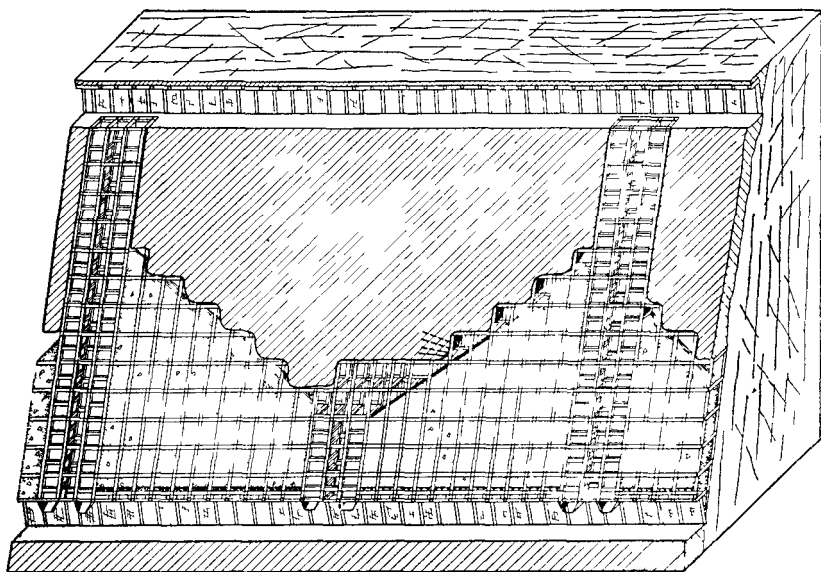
Потолкоуступная система со станковой крепью и закладкой
